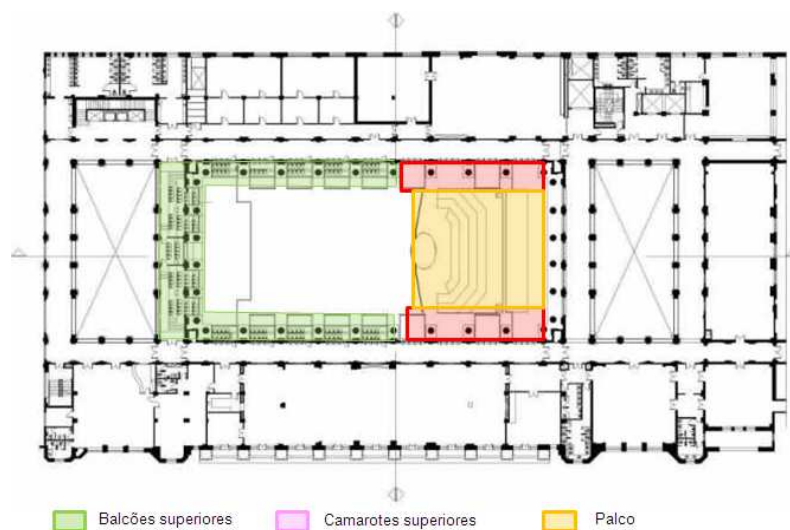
Planta baixa 1º pavimento Sala São Paulo
